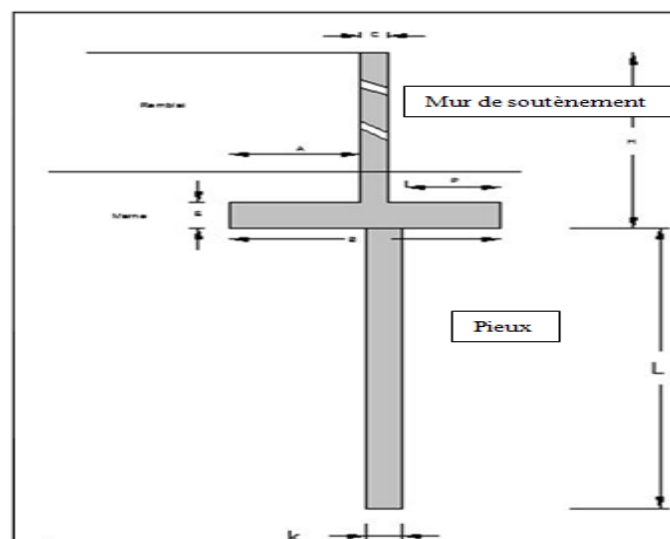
Schéma de dimensionnement d'un mur sur pieux.
